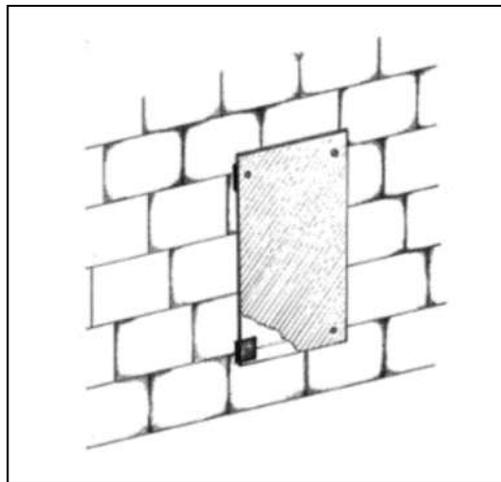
Illustration d'une plaque refuge pouvant être mise en pied de bâtiment
